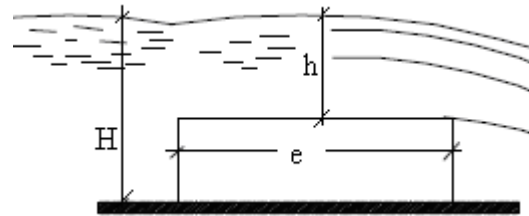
Perfil longitudinal de vertedor de parede espessa
